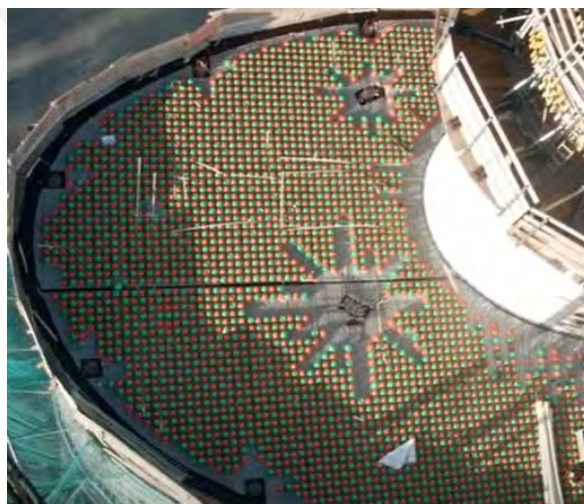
Retiro de solo las esferas ubicadas sobre el camino de las grietas que se generarían por punzonamiento
